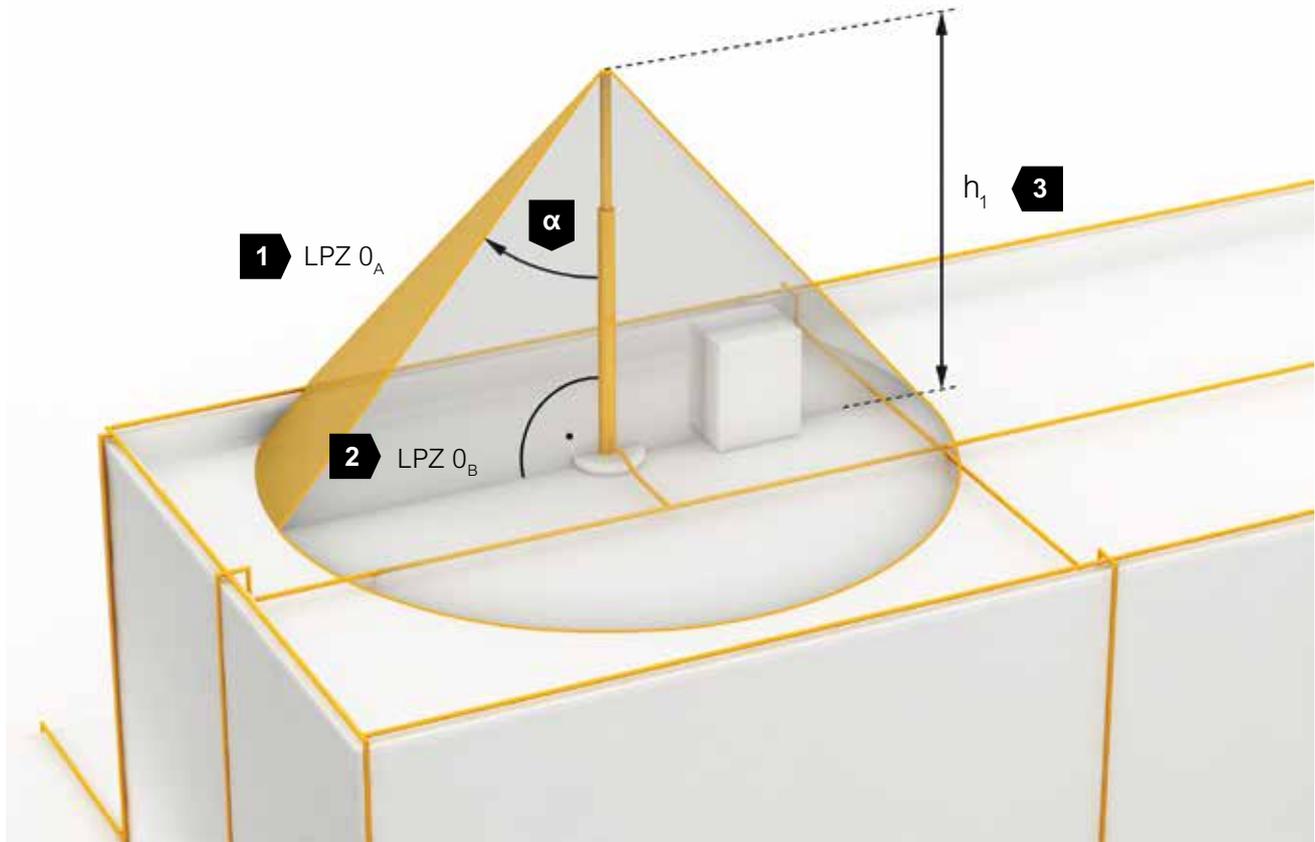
Mit dem vereinfachten Schutzwinkelverfahren errechnete geschützte Fläche einer Fangstange.
